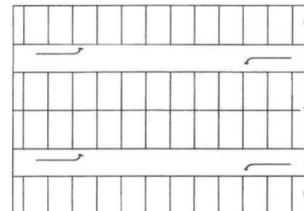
Parkir Sudut yang Berhadapan
